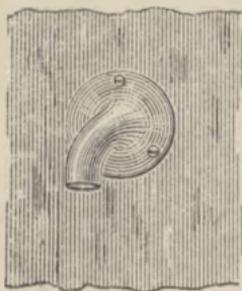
Montage d'un isolateur d'entrée à pipe.
